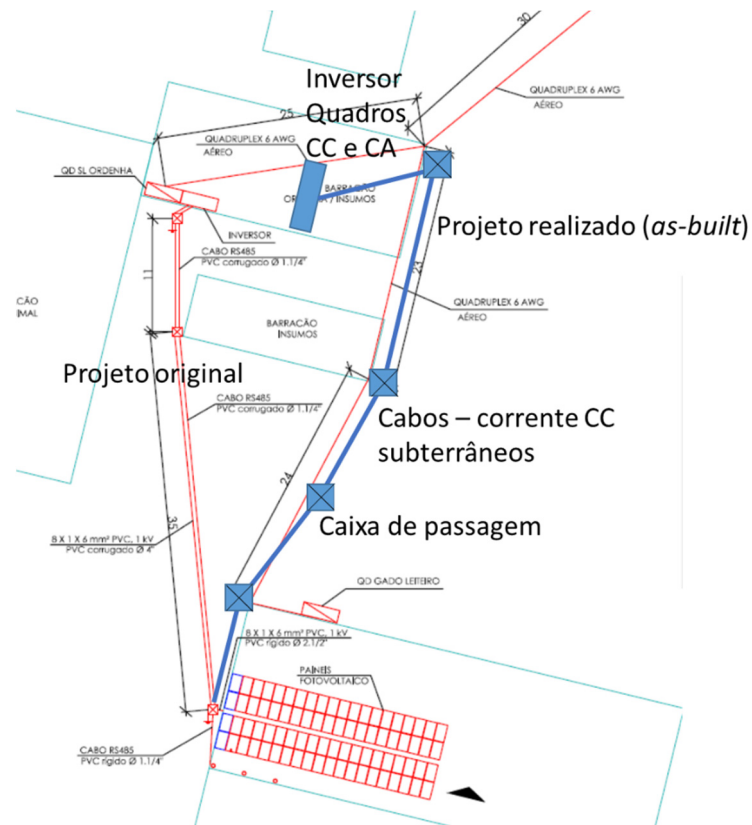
Planta da propriedade com o sistema fotovoltaico (Planta de situação). Projeto da empresa BSE Solar.
